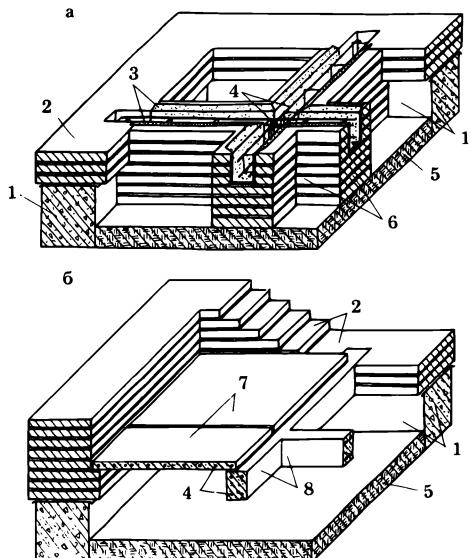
Вариант устройства цокольного сборно-монолитного железобетонного перекрытия
